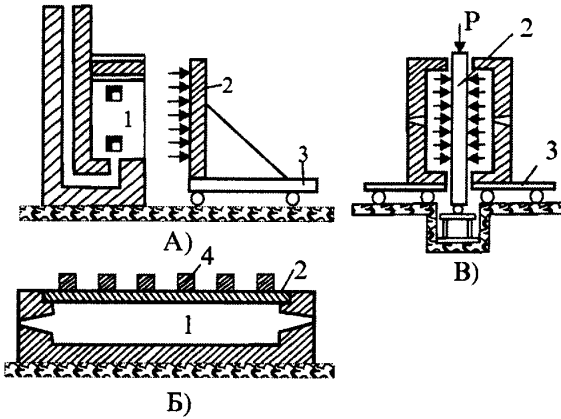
Схемы огневых установок для испытаний различных строительных конструкций на огнестойкость:
